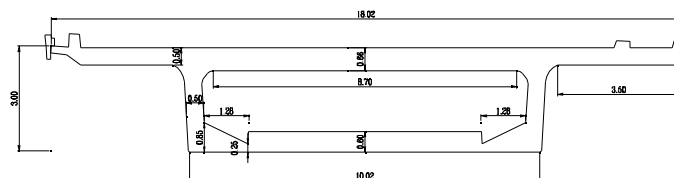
Corte transversal do tabuleiro na zona de transição – Pilar P5
